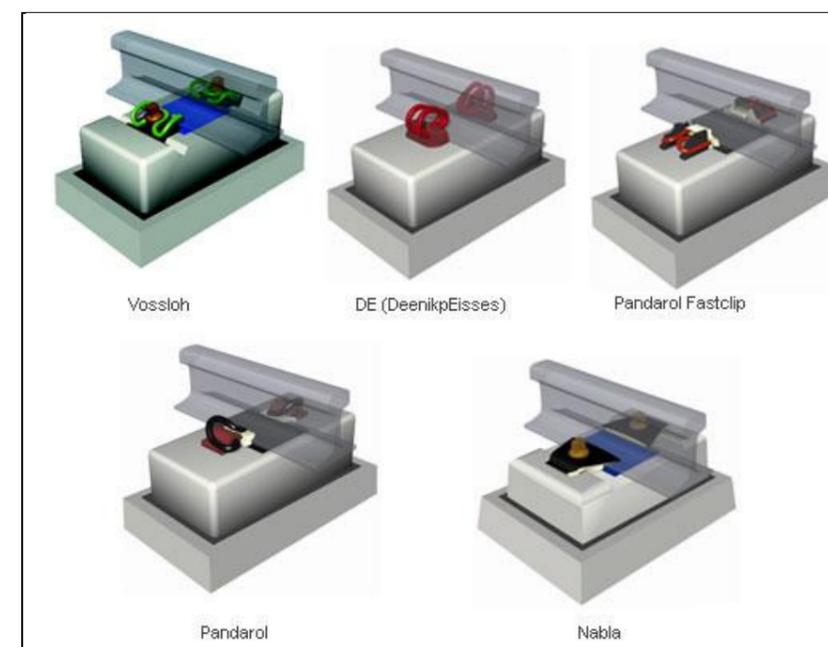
exemples de systèmes de fixation du rail sur traverse.
